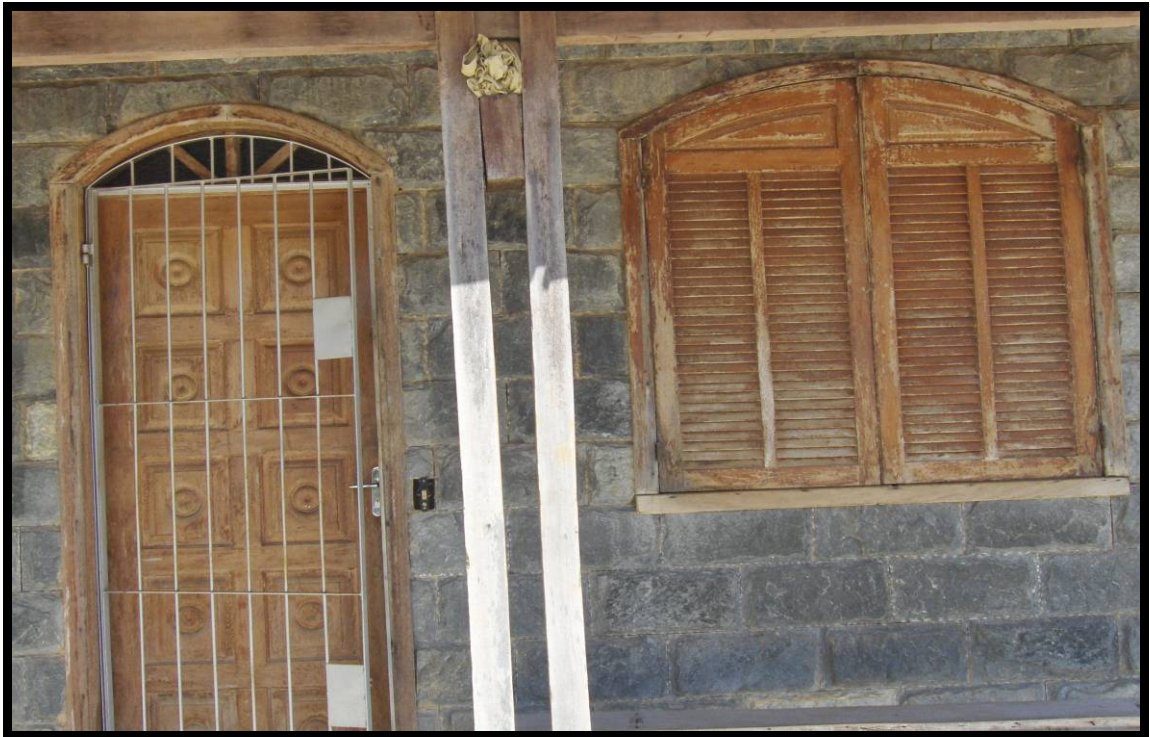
Emprego da pedra Lagoa Santa no revestimento de paredes
